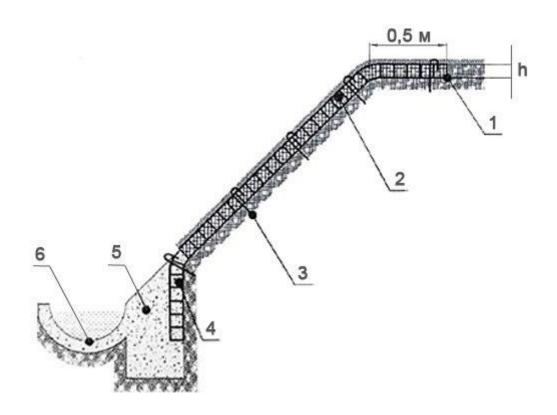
Схема укрепления склона с дополнительным усилением бетонным упором 1 — Объёмная георешётка; 2 — растительный грунт; 3 — крепёжные анкеры; 4 — бетон; 5 — щебень средней фракции; 6 — бетонный упор; 7 — отлитый из бетона водоотводный лоток.
